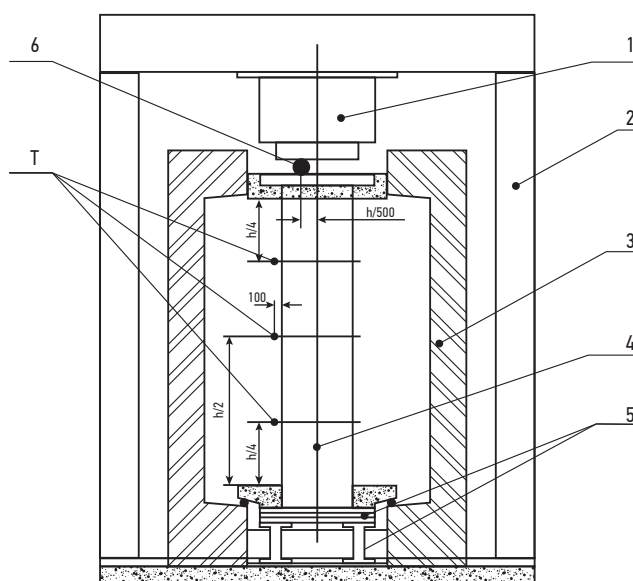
Пример расположения образца колонны при проведении испытаний под нагрузкой
